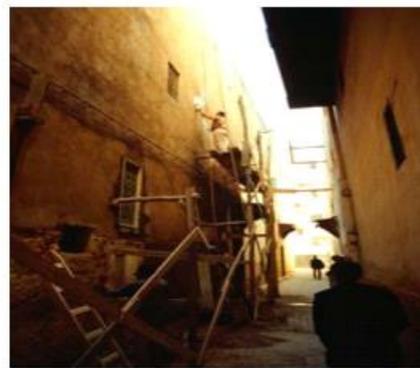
Travaux de ravalement de façade d'une vieille maison
